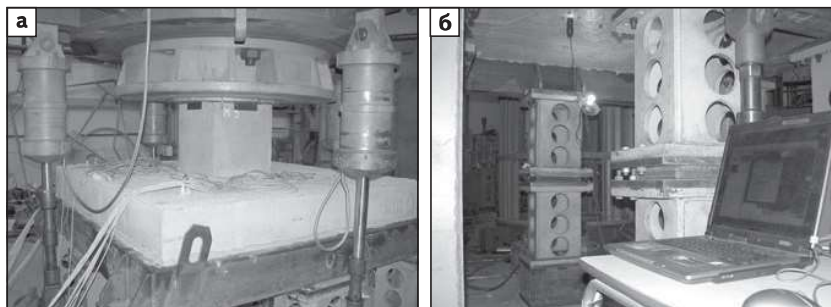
Образцы в испытательном стенде (а – вид сбоку; б – вид снизу)
